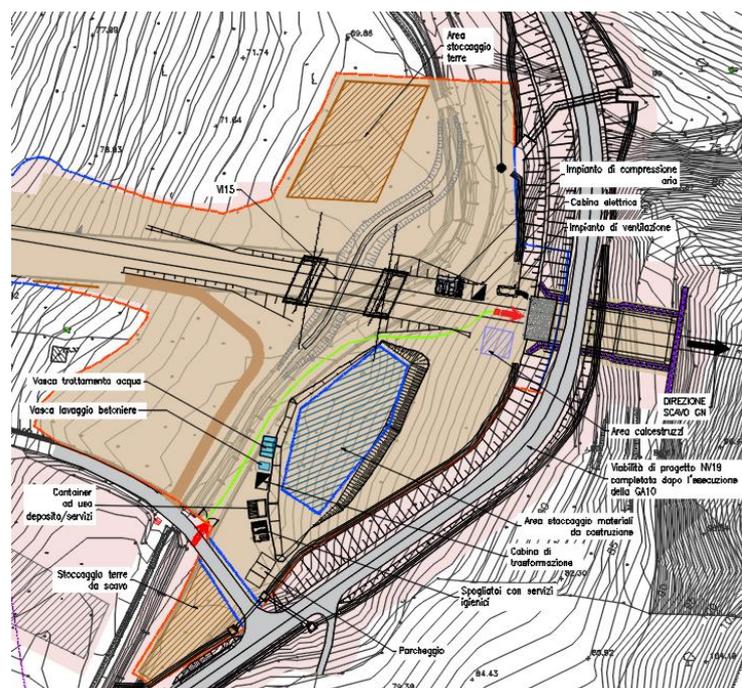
Planimetria cantiere scavo GN04 S. Lorenzo
